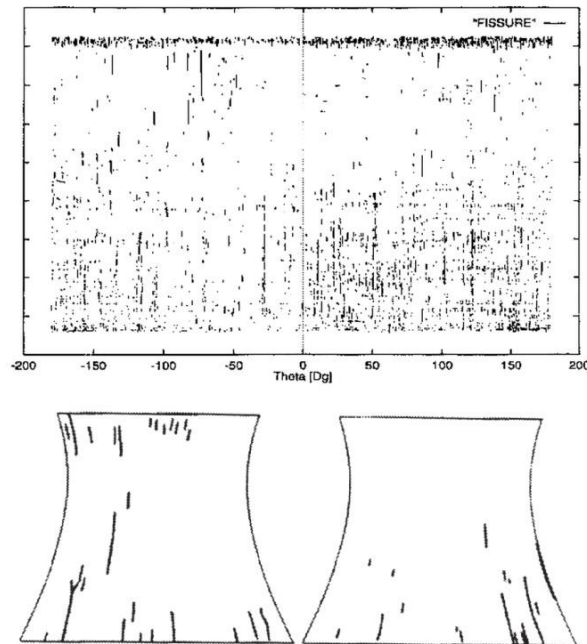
Faciès de fissuration d'un aéroréfrigérant représentés en plan [137]
